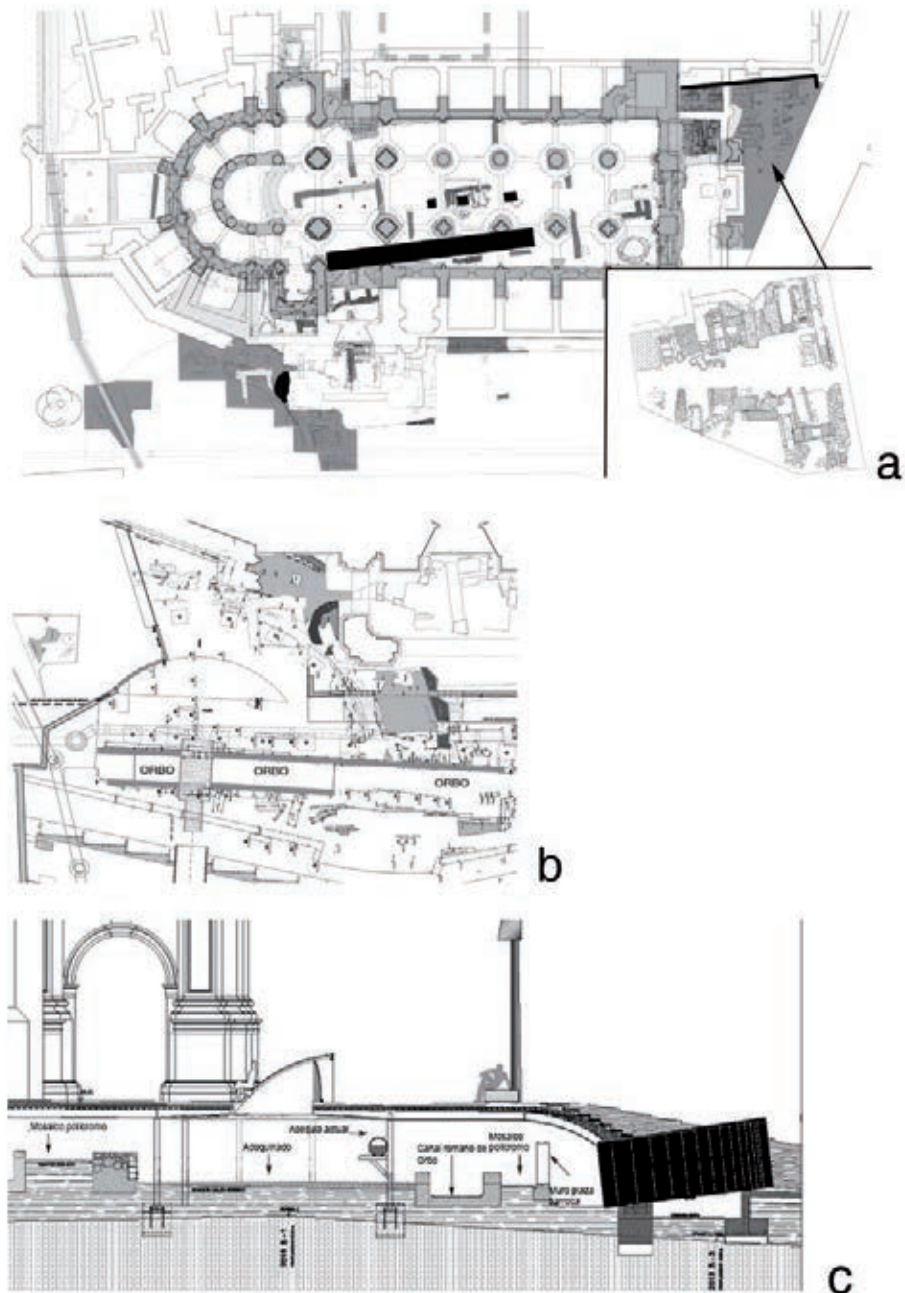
Plantas y secciones. a) En negro las estructuras correspondientes a la basílica y baptisterio (plano equipo Plan Director). b) Planta del recinto arqueológico. Estado actual. c) Sección del recinto arqueológico (plano F. Aguerri y J.I. Aguerri).
